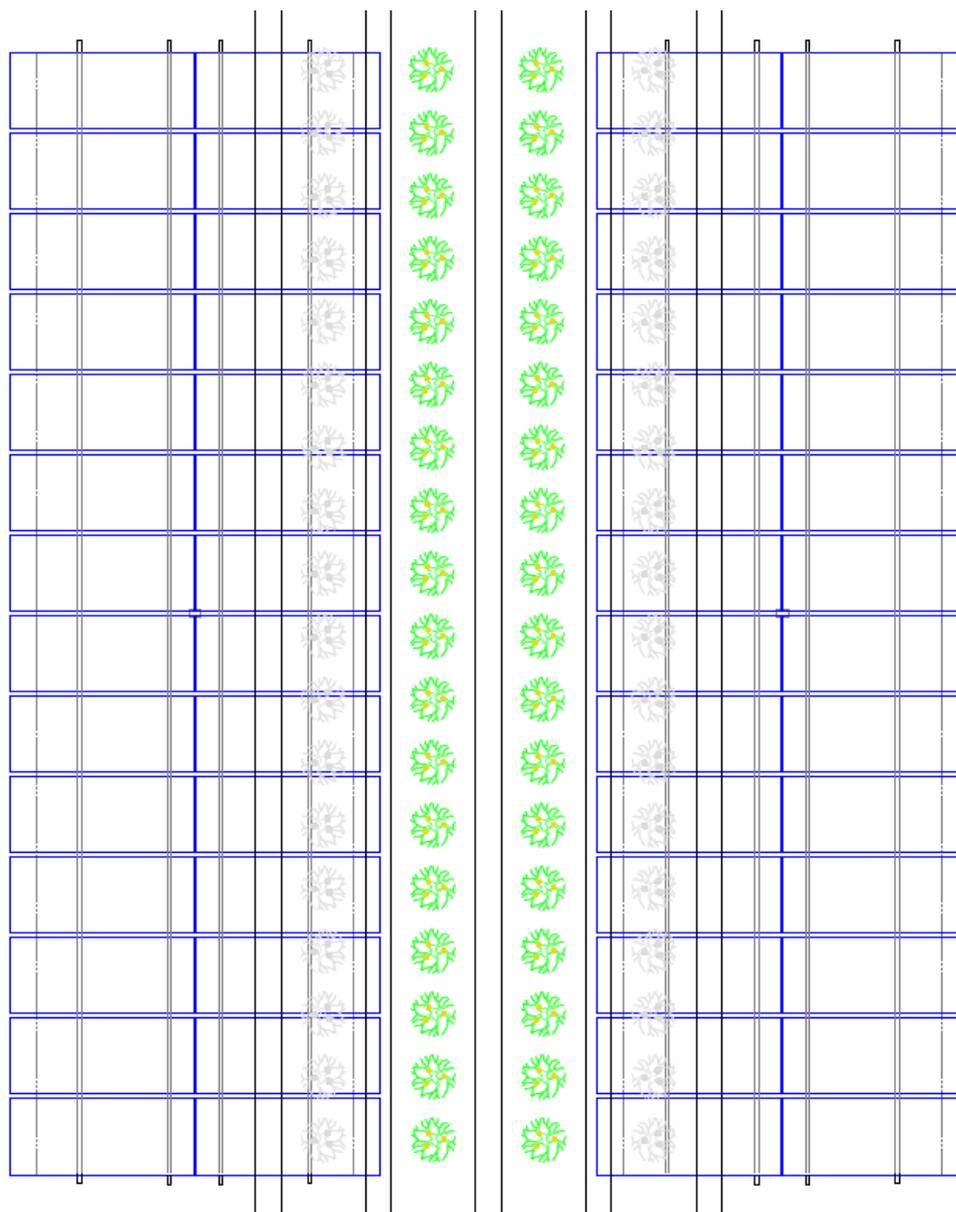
Piantumazione tra le file di tracker (vista dall'alto)
